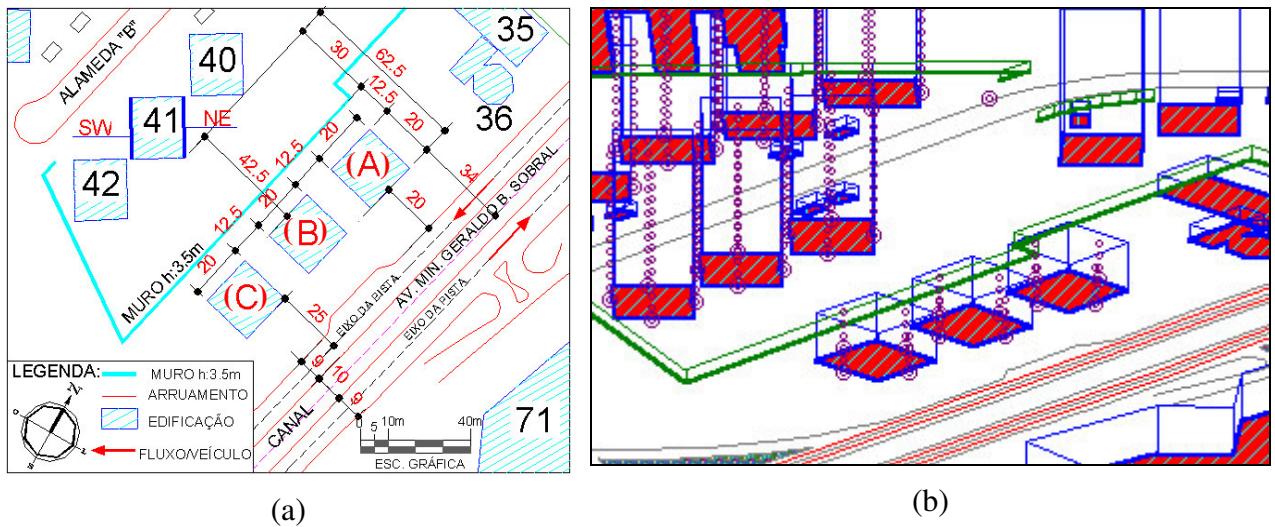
(a) Planta-baixa do CASO 3b e (b) modelo 3D do CASO 3b (Vista Sudeste).
